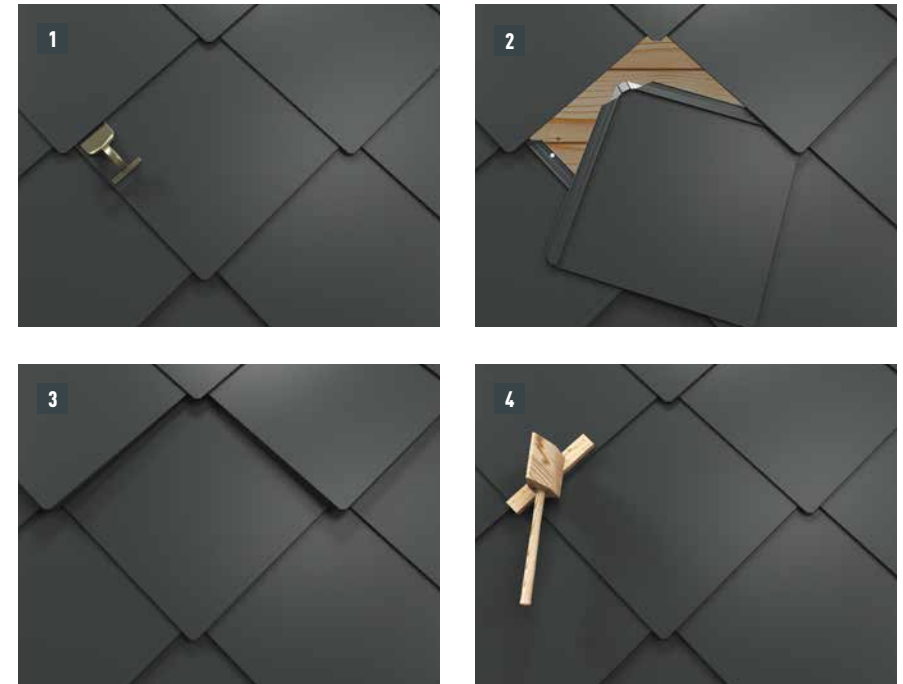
• Losange de façade 44 × 44 – sens de couverture et fixation
